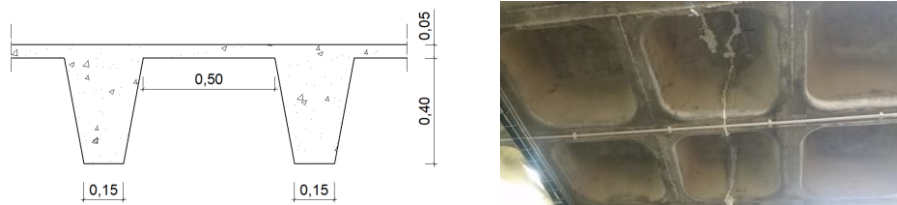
| Laje existente: representação em corte e aspeto da face inferior
